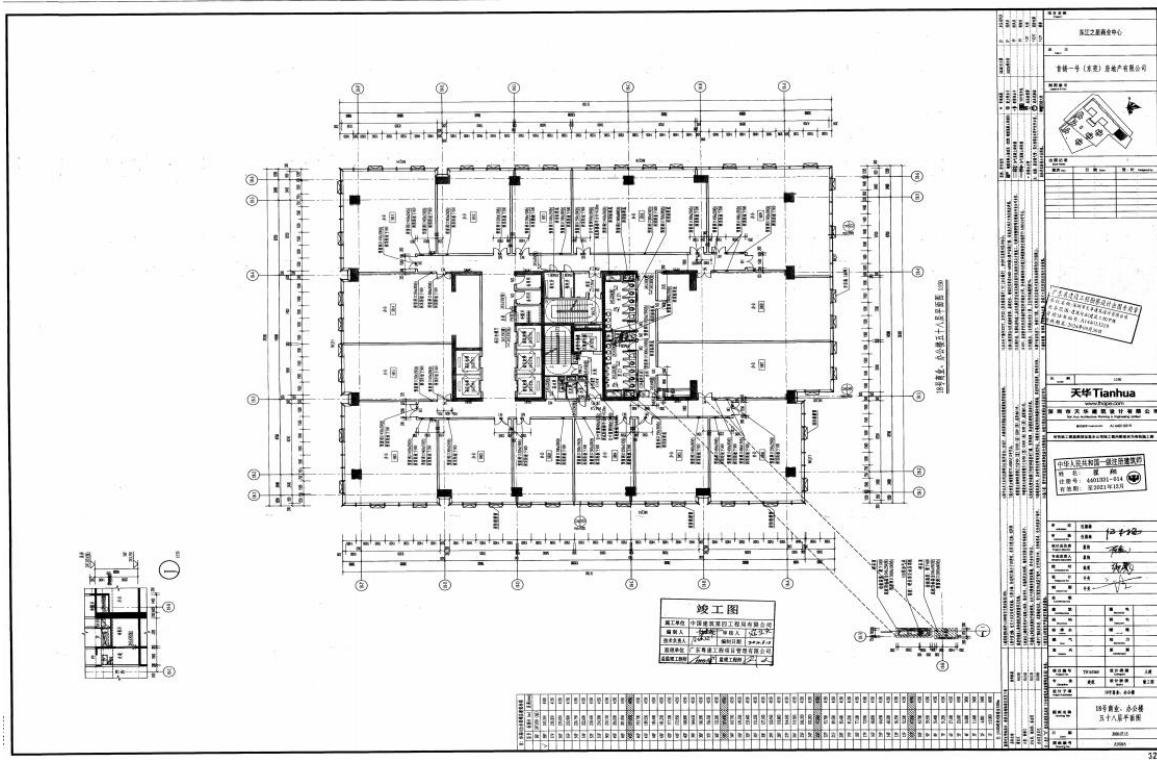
东江之星商业中心 18 号写字楼 58 层平面图
